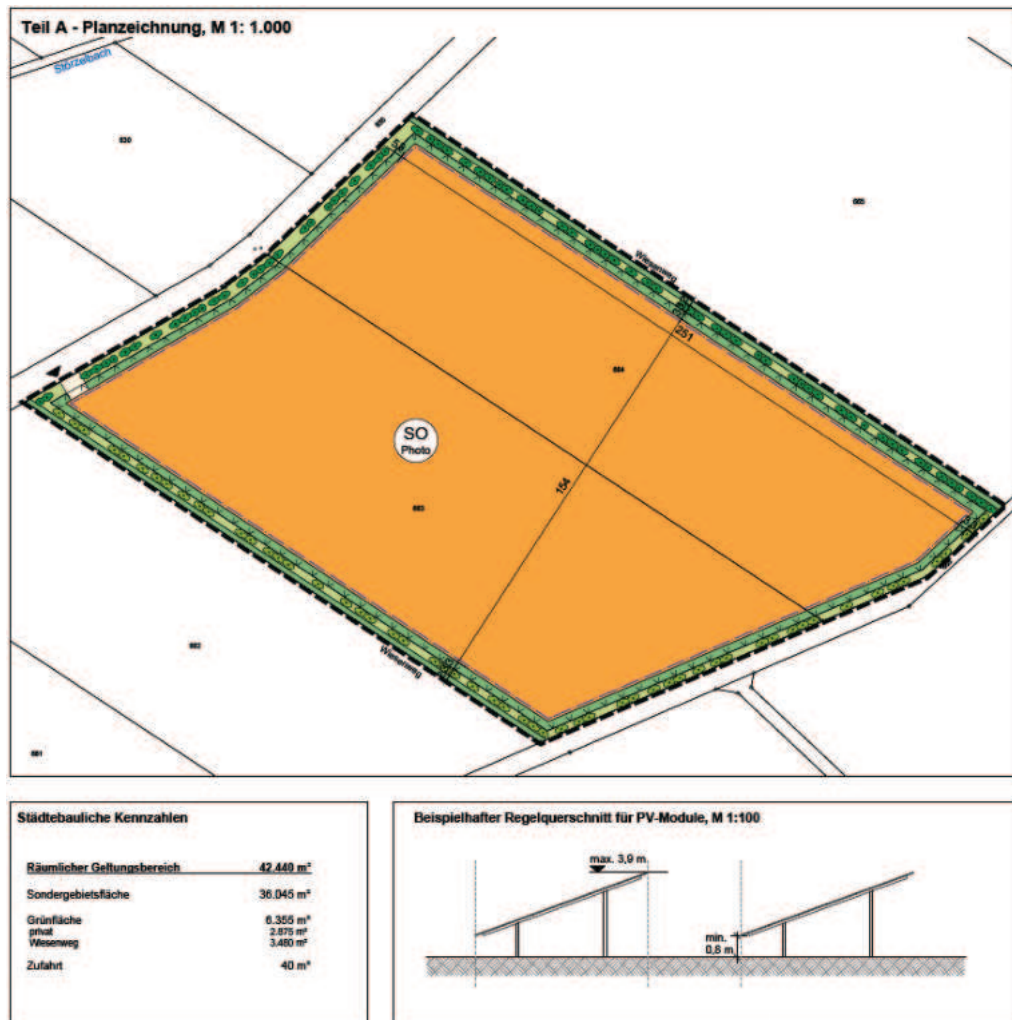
Ausschnitt Planzeichnung B-Plan „Solarpark Alesheim“
